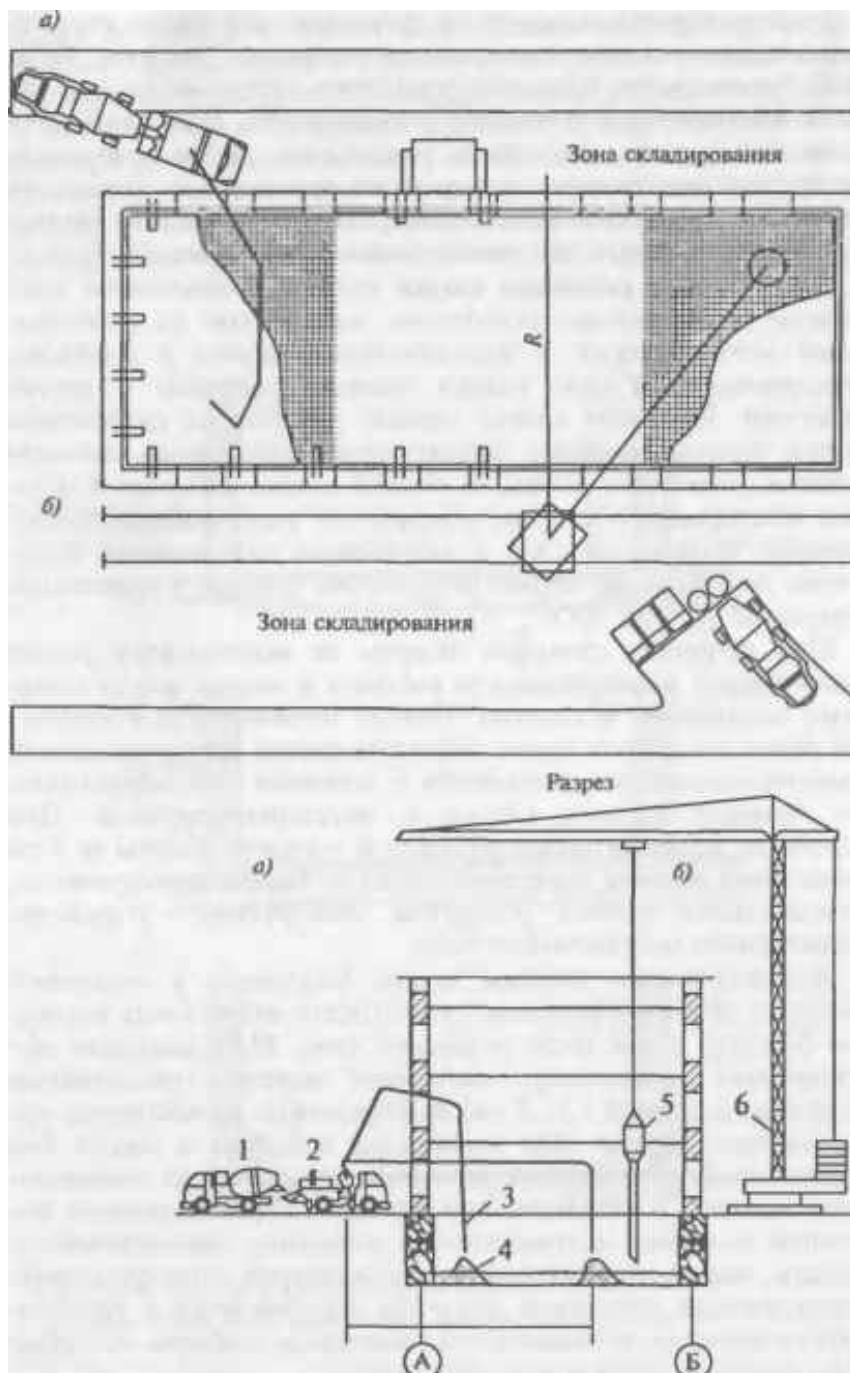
Схемы бетонирования монолитных плитных фундаментов:
